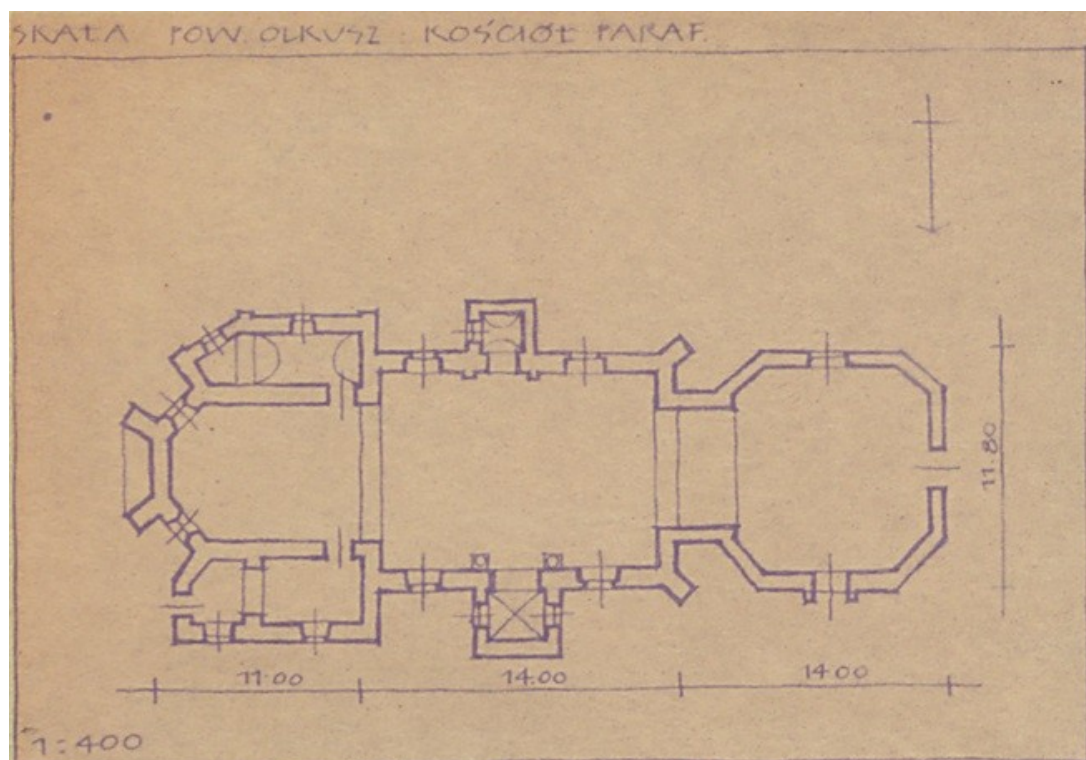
Zdjęcie archiwalne z 1967 roku.
